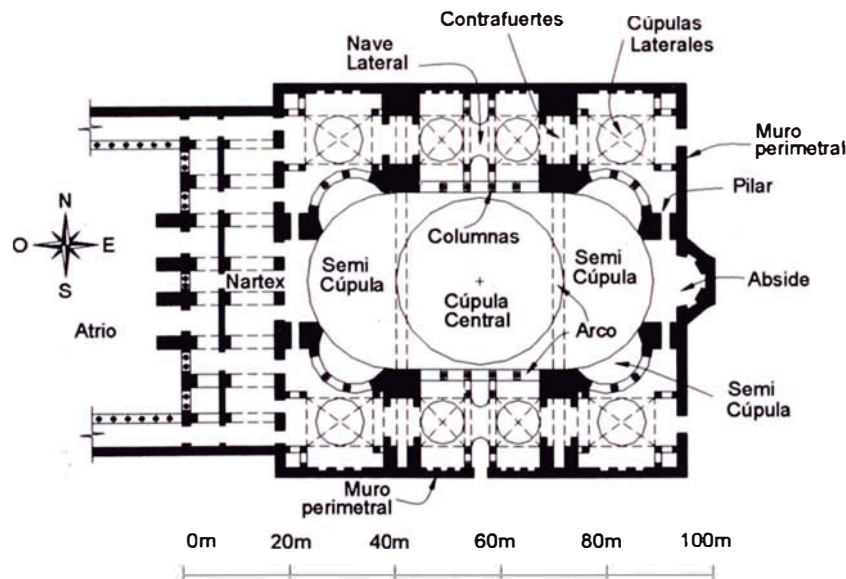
Planta de la basílica Santa Sofía (ó Hagia Sofía)
